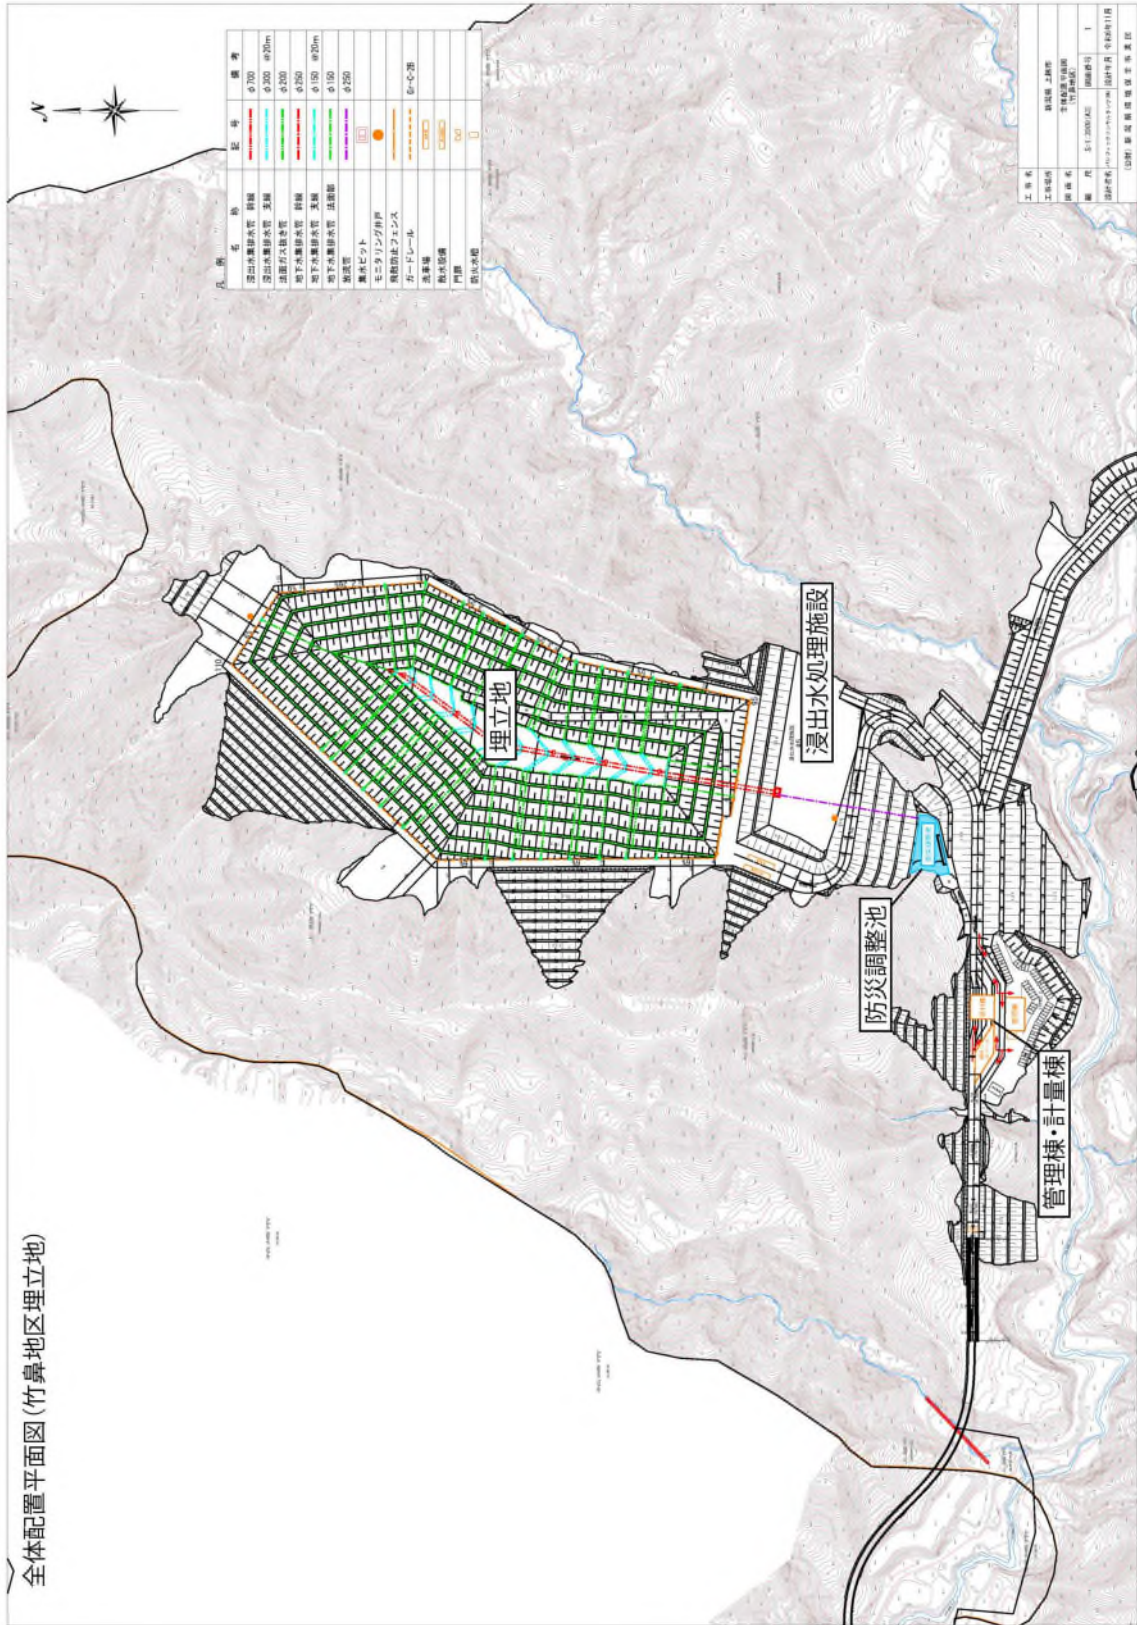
(1) 全体配置平面図(竹鼻地区埋立地)
